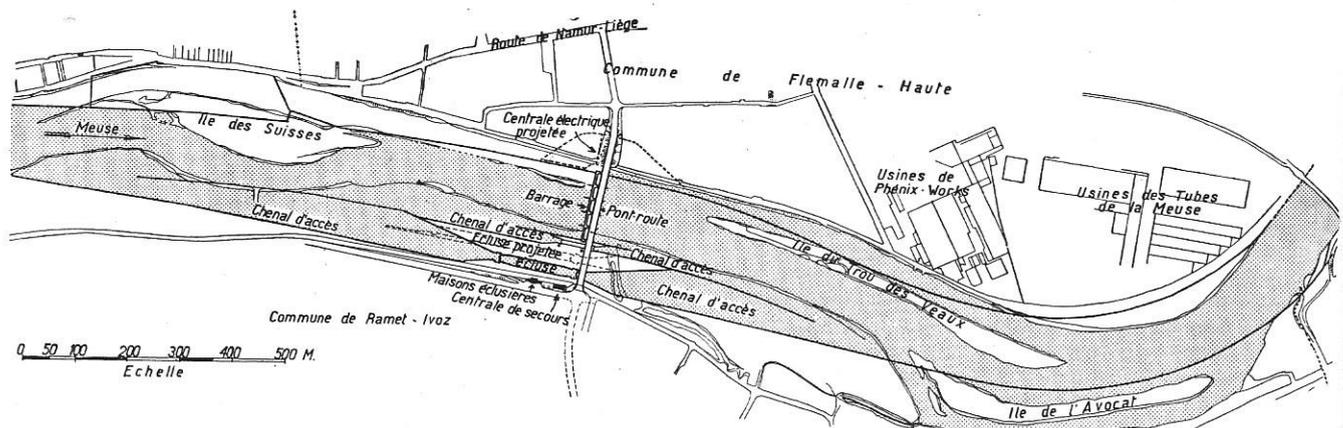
Plan de situation schématique des ouvrages de Ramet-Ivoz.
